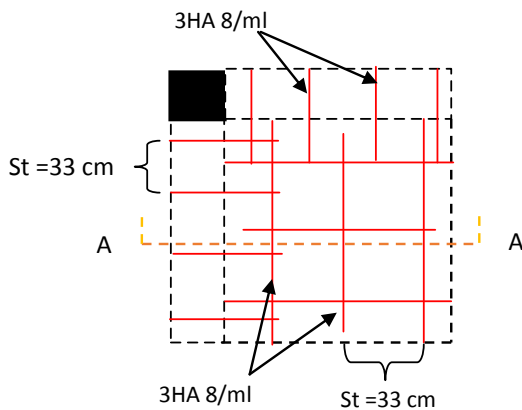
schémas de Ferrailage de la dalle sur 2 appuis (Dp5)
